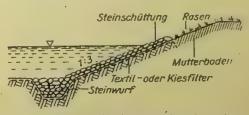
Steinschüttung mit Steinwurf auf Filterunterbettung und anschließender Rasendecke
